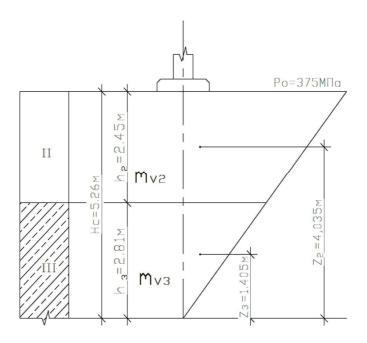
Расчётная схема осадки фундамента метолом эквивалентного слоя
